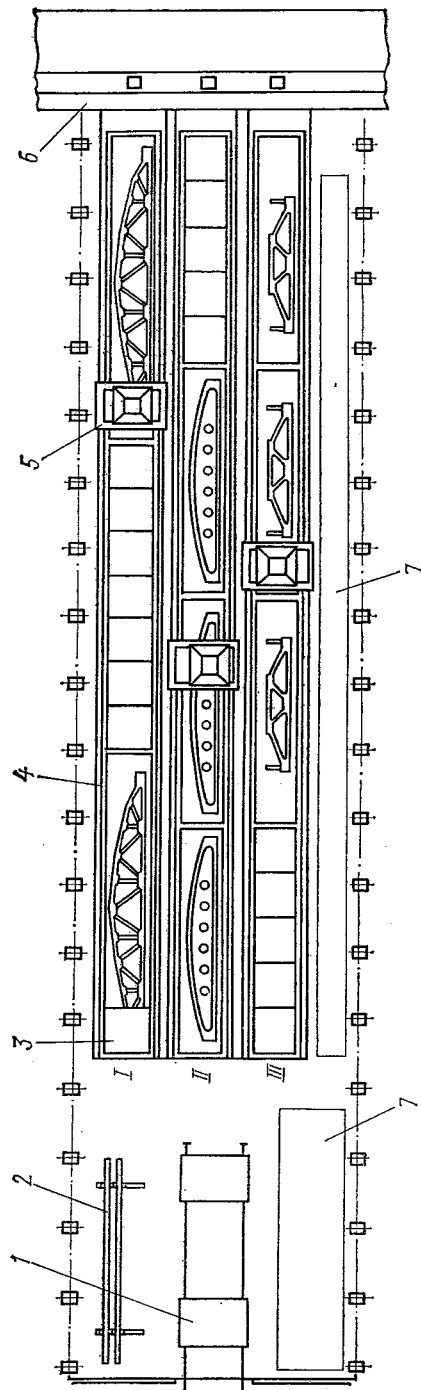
План формовочного цеха со стендовой схемой производства предварительно напряженных железобетонных конструкций в силовых формах.
